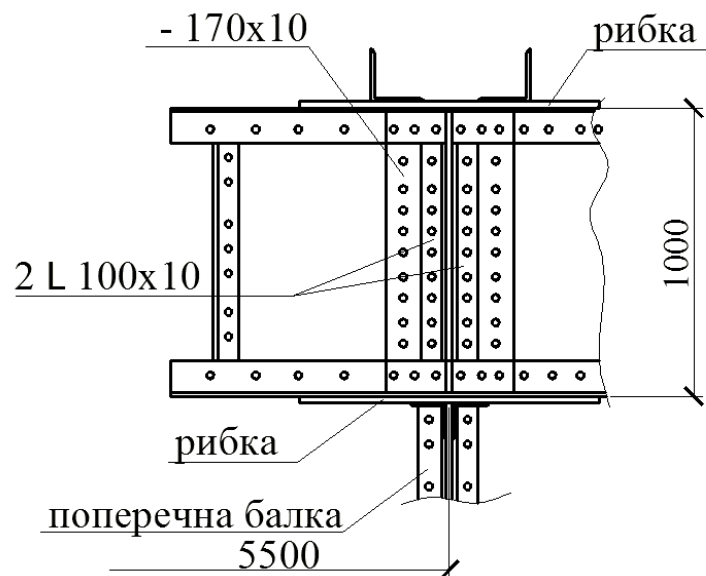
Обпирання поздовжньої балки на поперечну
